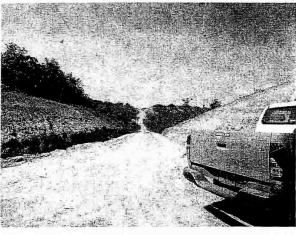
Carretera de la empresa Plantaciones de Ucayali SAC.
